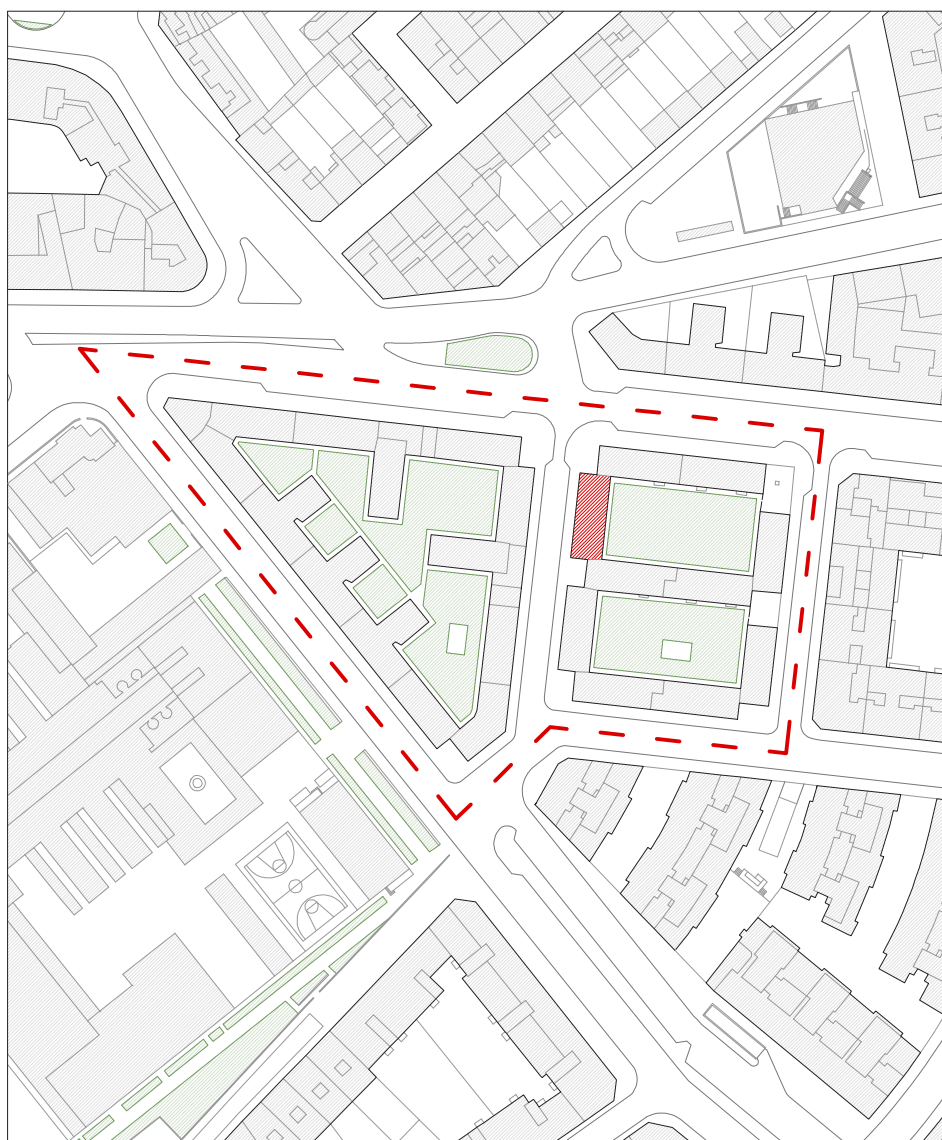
Plano de emplazamiento del caso de estudio (e: 1/2.000).
